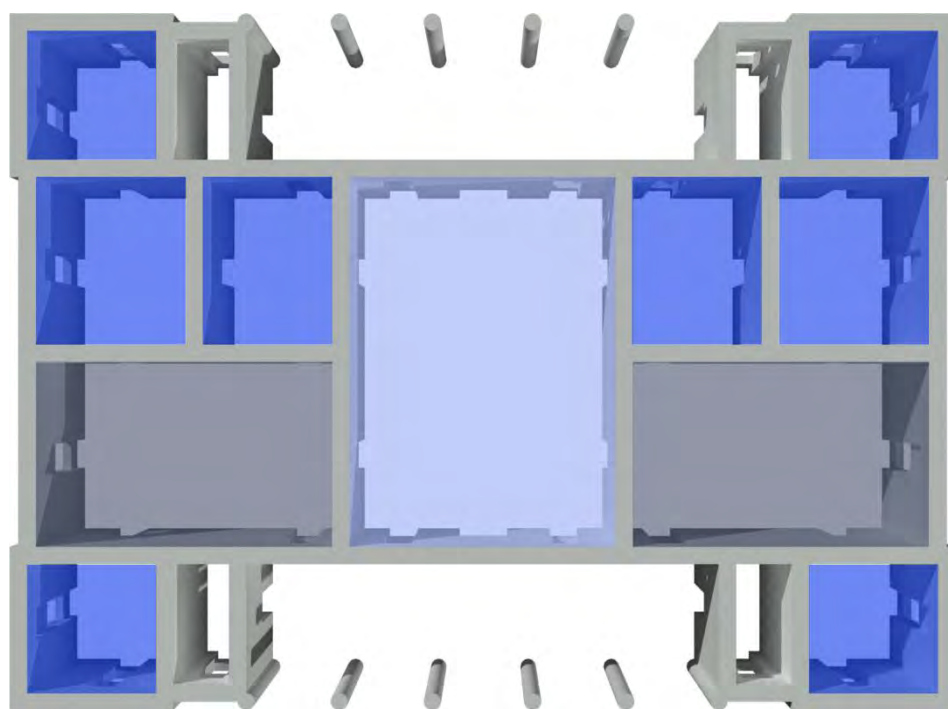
Ridisegno del progetto pubblicato da Palladio e determinazione della pianta della villa
